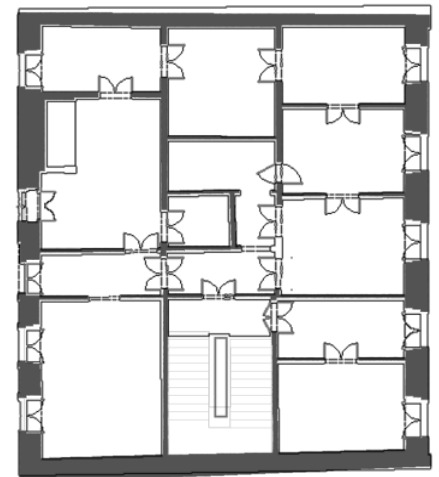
Planta de apartamento com organização espacial original e sobreposição de portas e janelas nos vãos originais, criação do autor.
